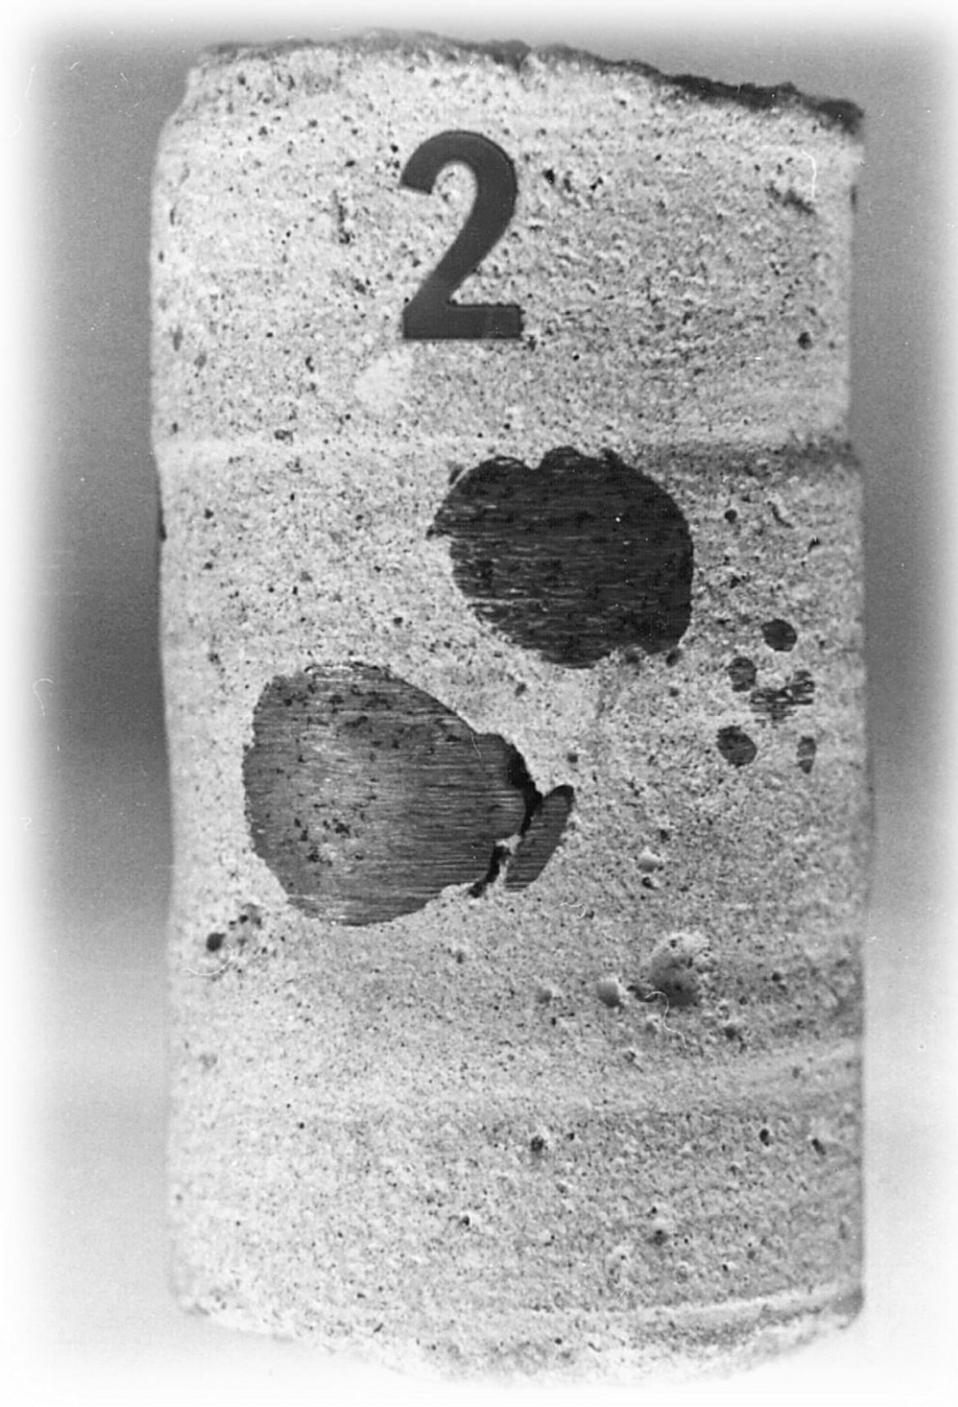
"Grado 2". Fuente: (American Concrete Institute, 1995)
